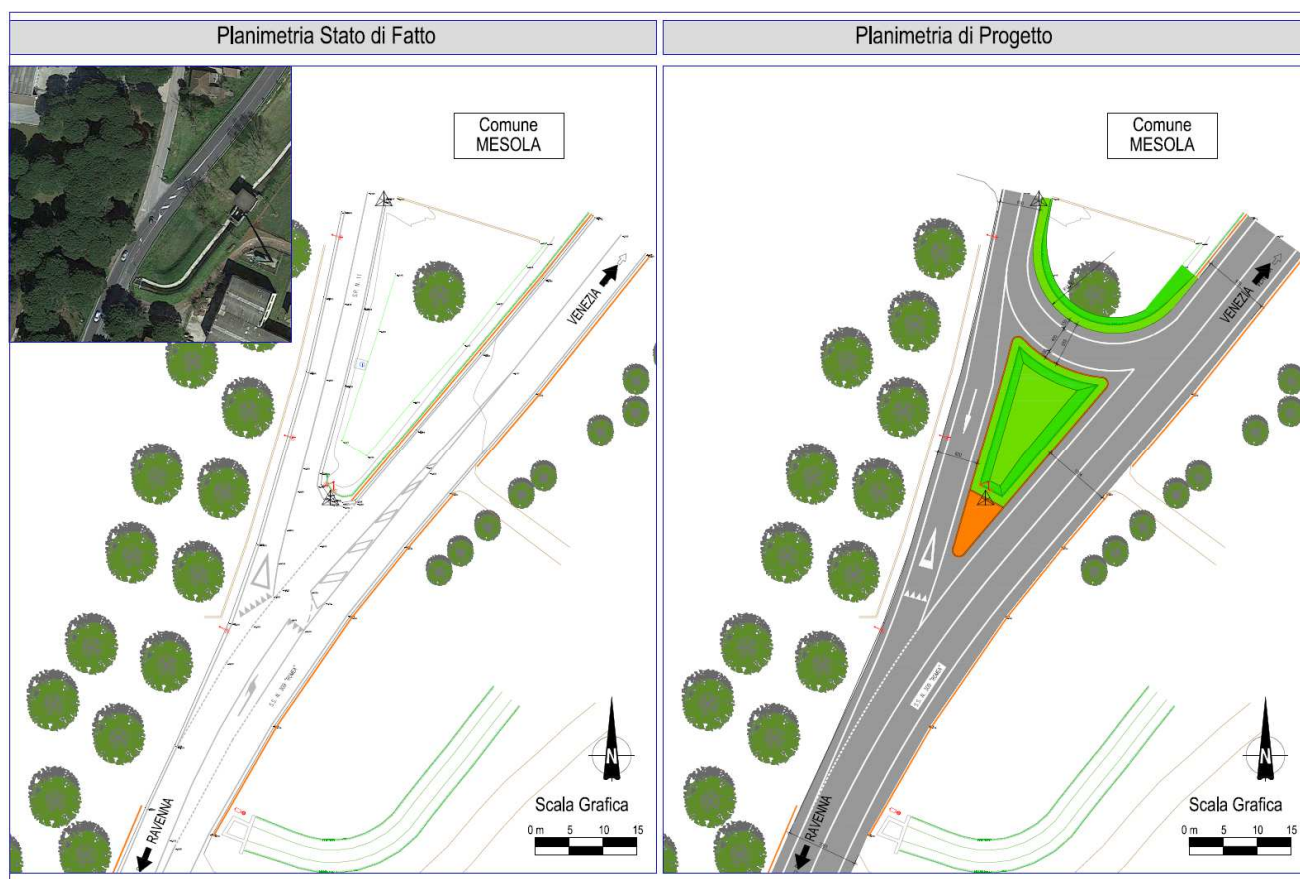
Intervento n° 22 – Planimetria Stato di fatto - Progetto
